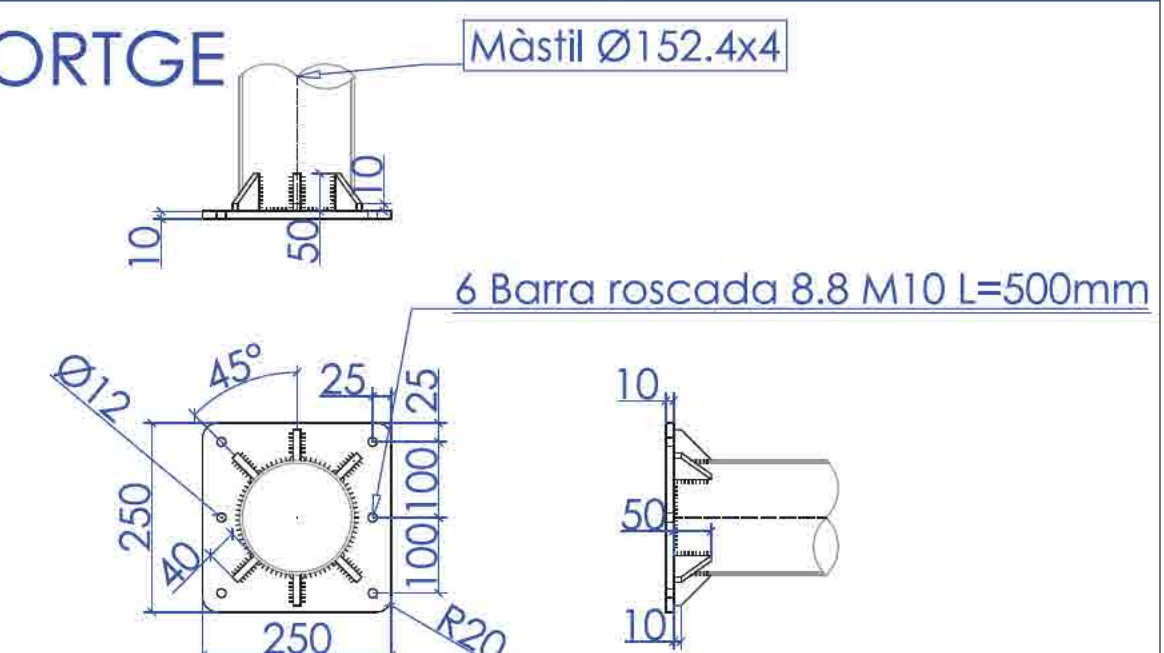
10 (A1) 1:20 (A3)-Cotes en mm
